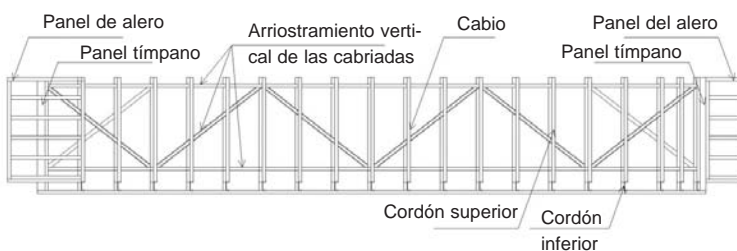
Vista lateral de la estructura del techo mostrando el arriostramiento del sistema de cabriadas.
